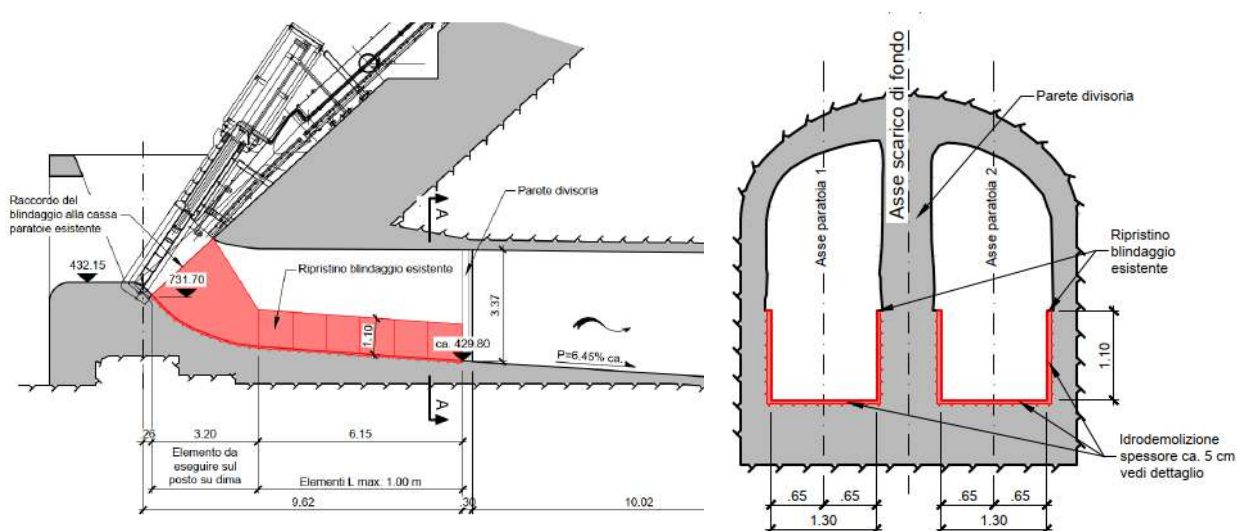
Sezione longitudinale e trasversale dello scarico di fondo, subito a valle delle paratoie, con indicazione del blindaggio da ripristinare in rosso
